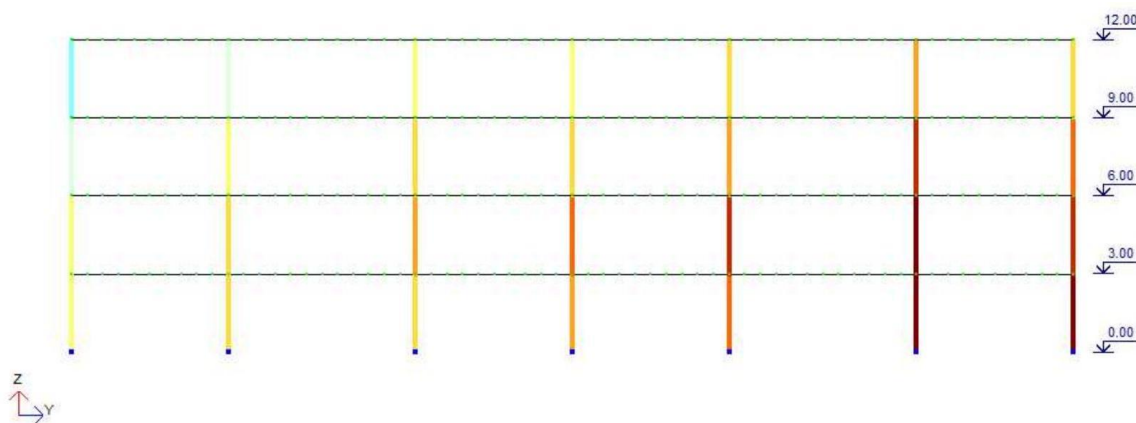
Поперечна арматура ASW1 у колонах рами по осі 7-7
